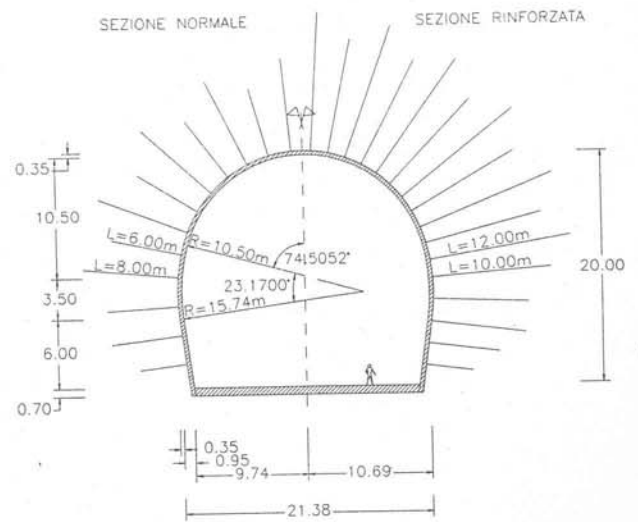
Geometria dello scavo del laboratorio «C» ed interventi di stabilizzazione.
